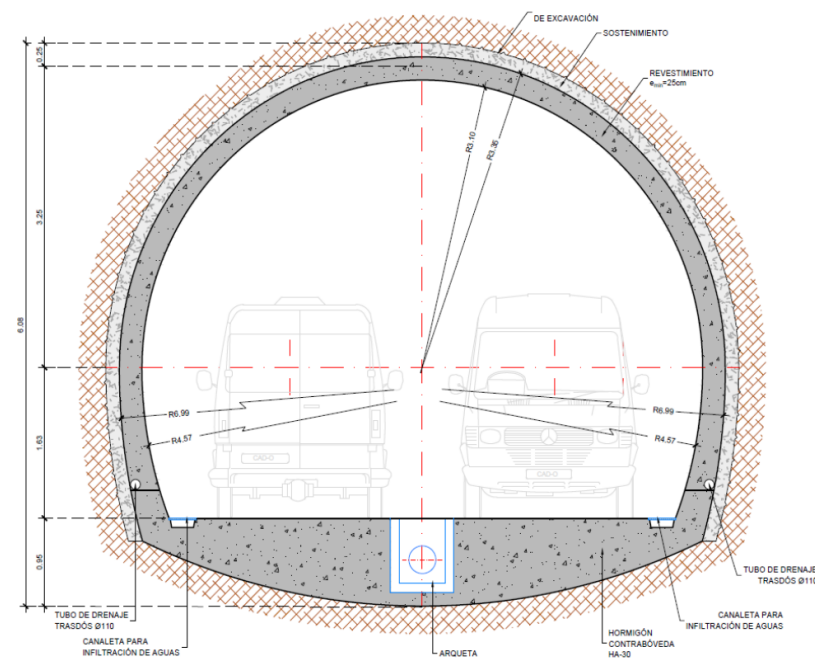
Galería de emergencia vehicular con contrabóveda.
